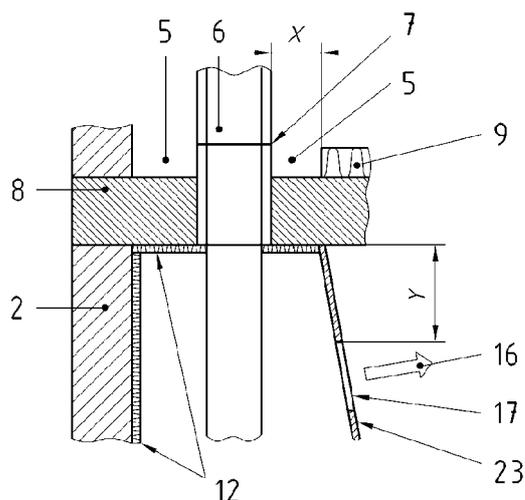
Exemple identique à la Figure D.3 sans faux plafond
